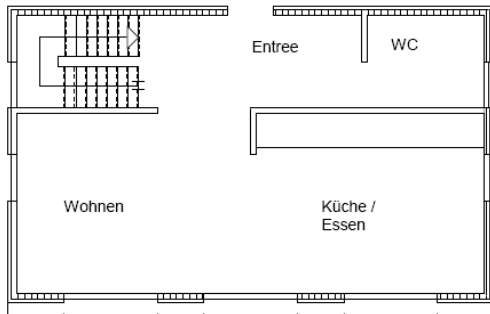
Grundriss des EFH's mit insgesamt drei Geschossen, wobei die oberen zwei Etagen aktiv beheizt werden.
